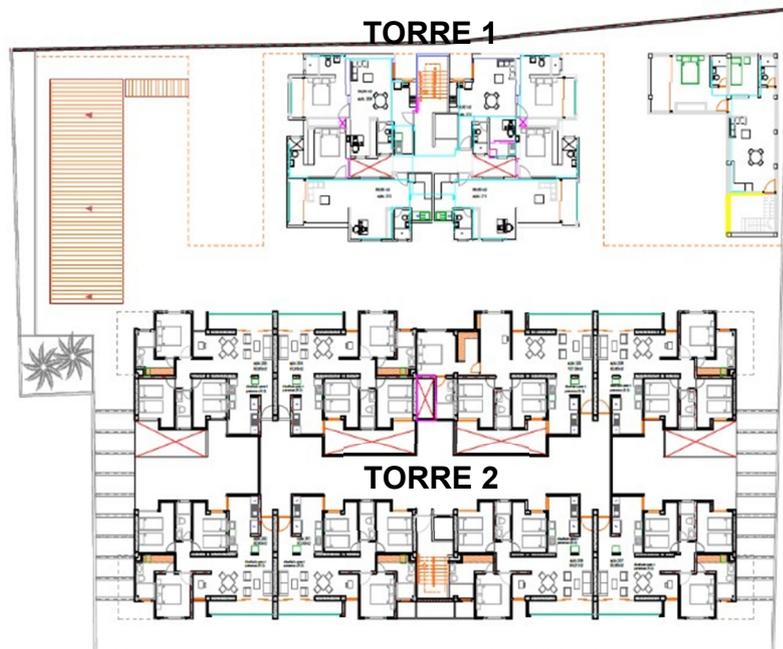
Planta 2º piso – Fuente: Memoria de Calculo Juan Felipe Agudelo Patiño
